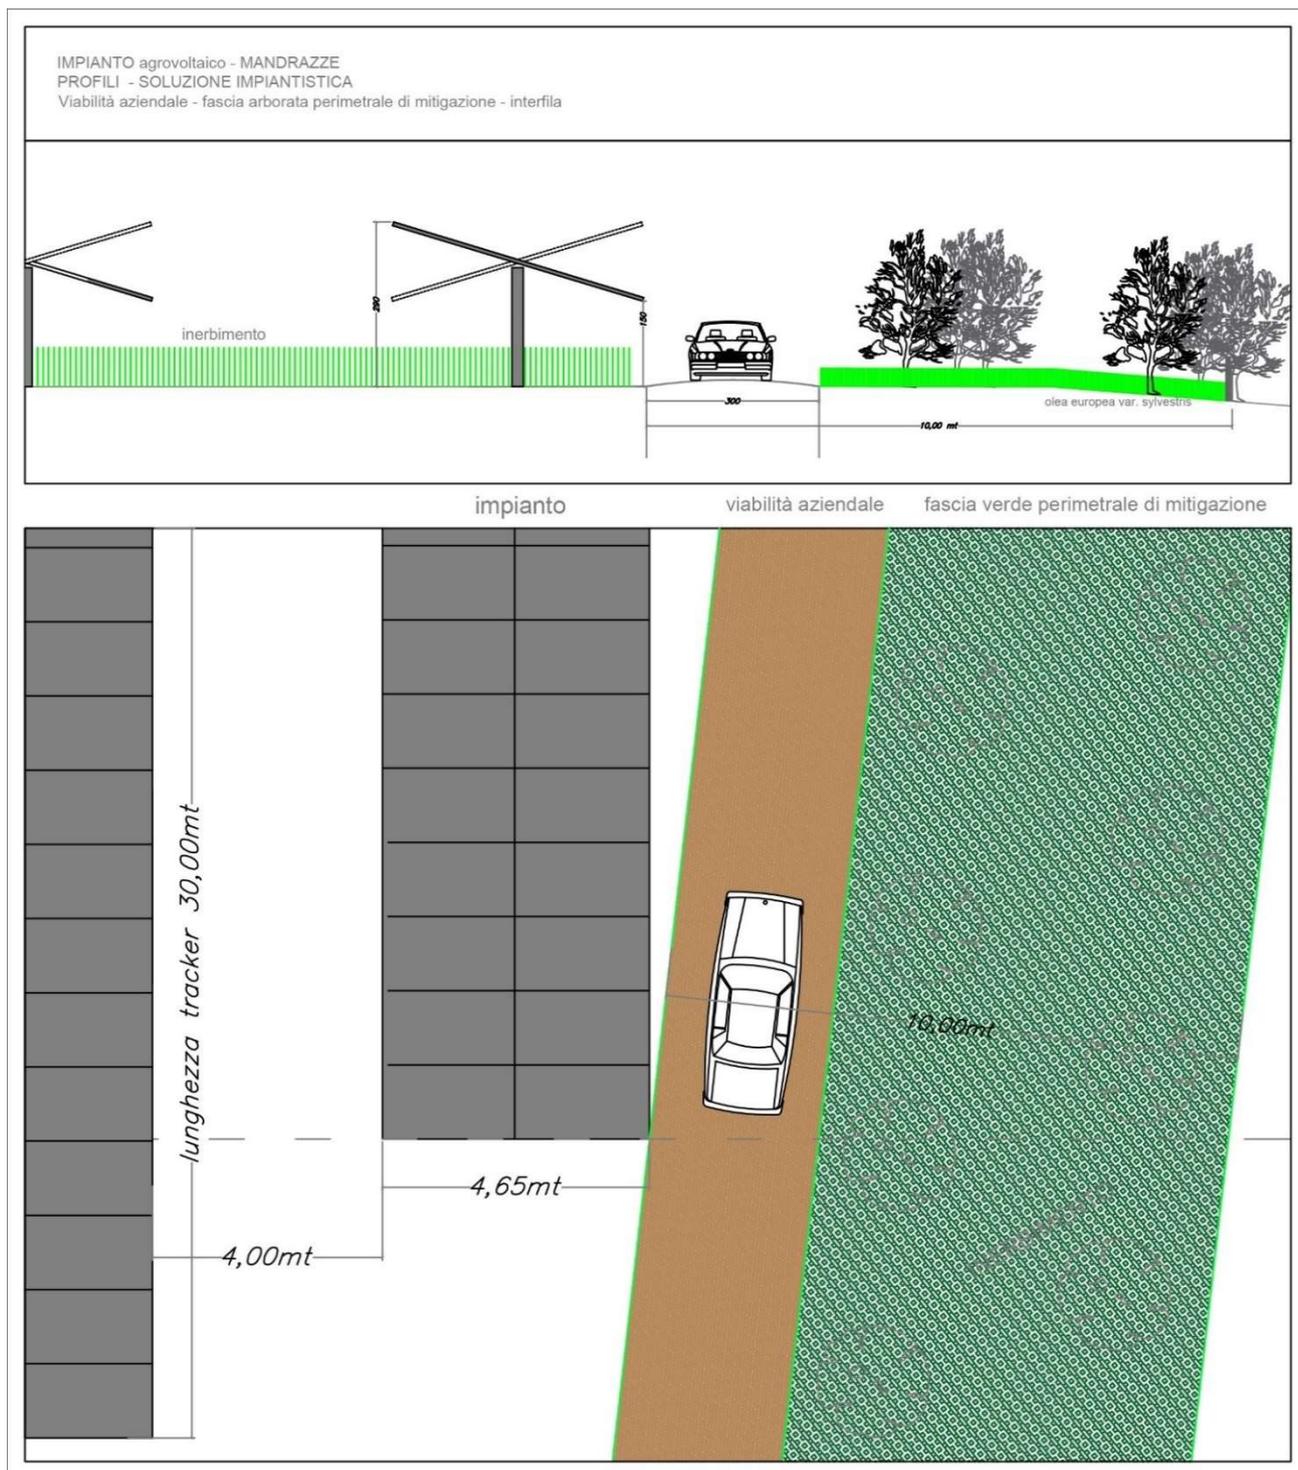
Profili e disposizione stringhe impianto Mandrazze
